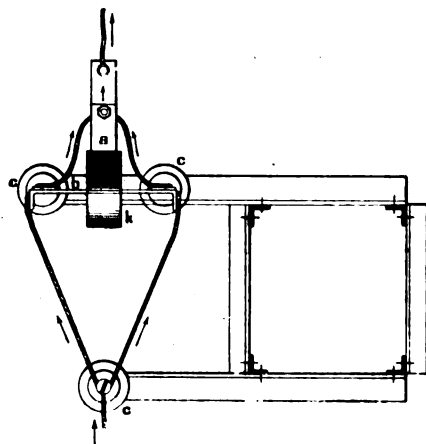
Vue en plan de l'installation du dispositif sur un pylone.
